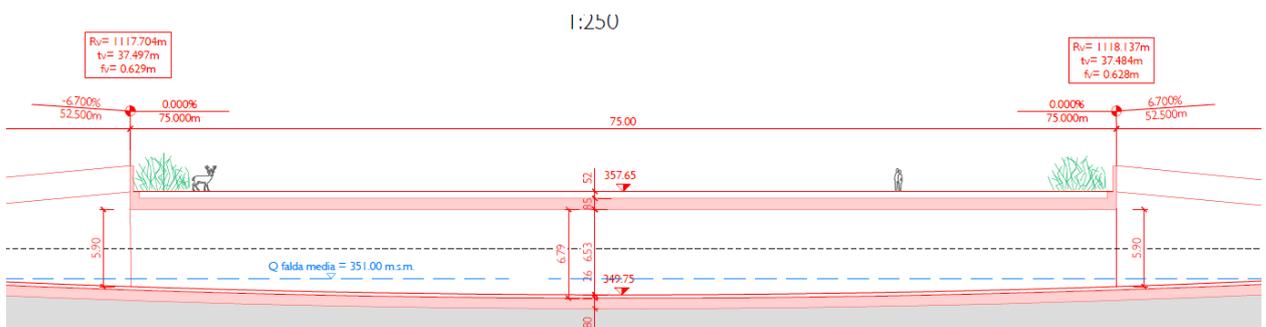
Profilo longitudinale del nuovo ponte faunistico – rampa lato Malvaglia
